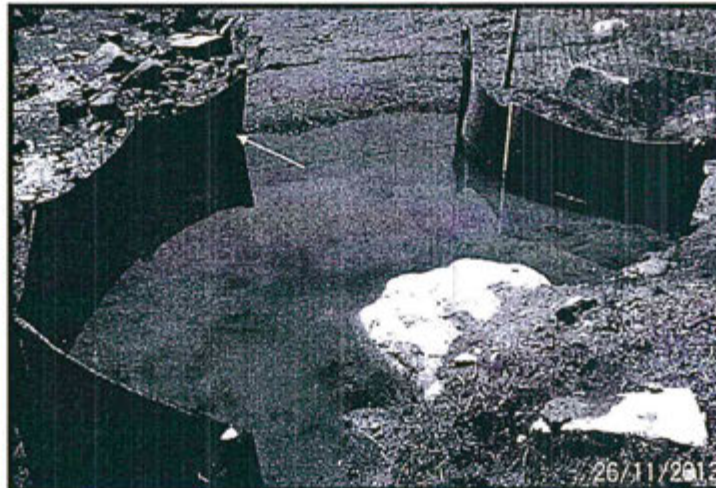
Hallazgo N° 1. Vista del canal que llega a la quebrada adyacente.
